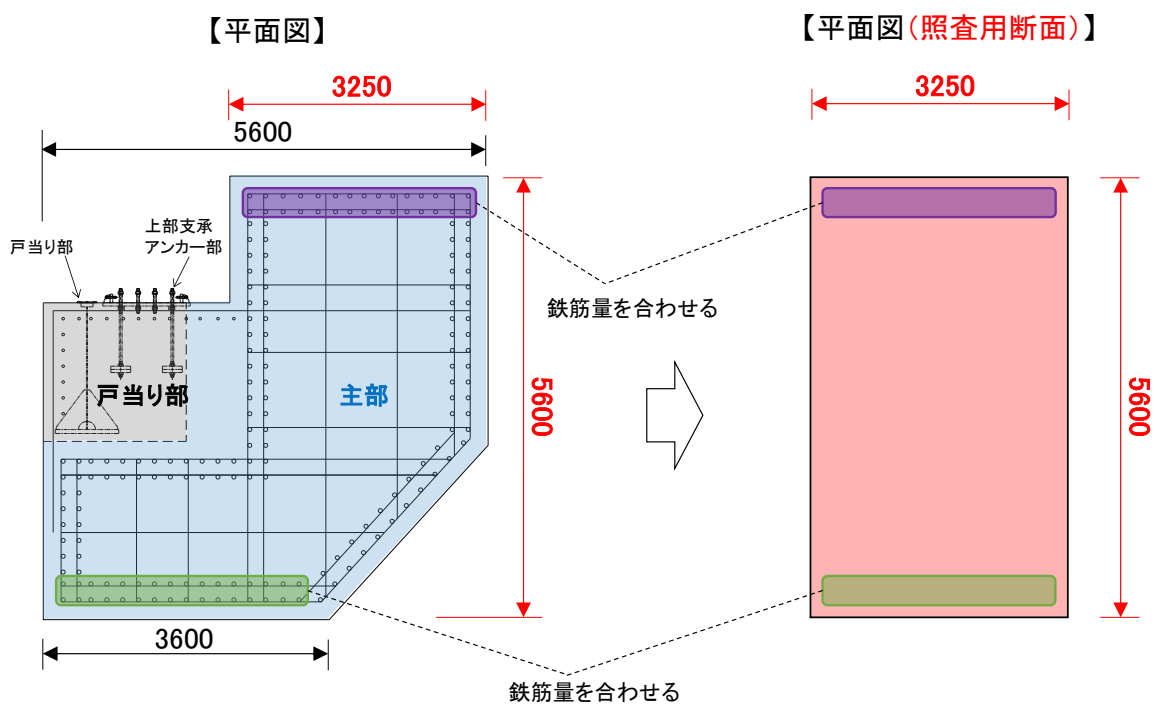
支圧板及び戸当り（腹板，底面フランジ，コンクリート）の評価イメージ図
